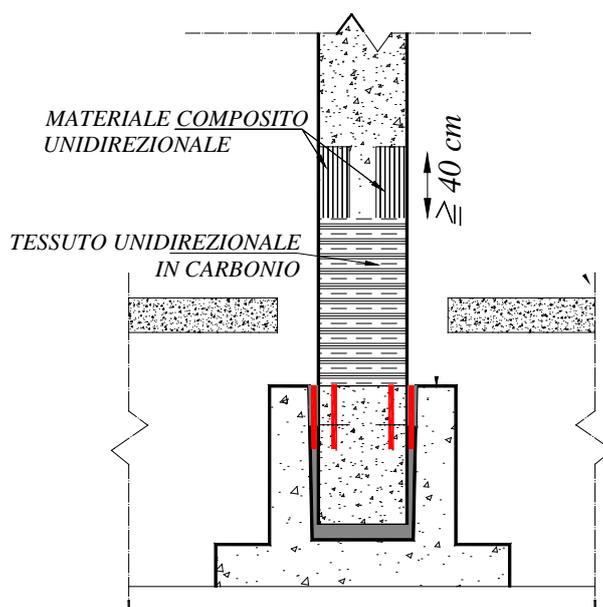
Particolare sommitale in caso di ripresa successiva dell'intervento
